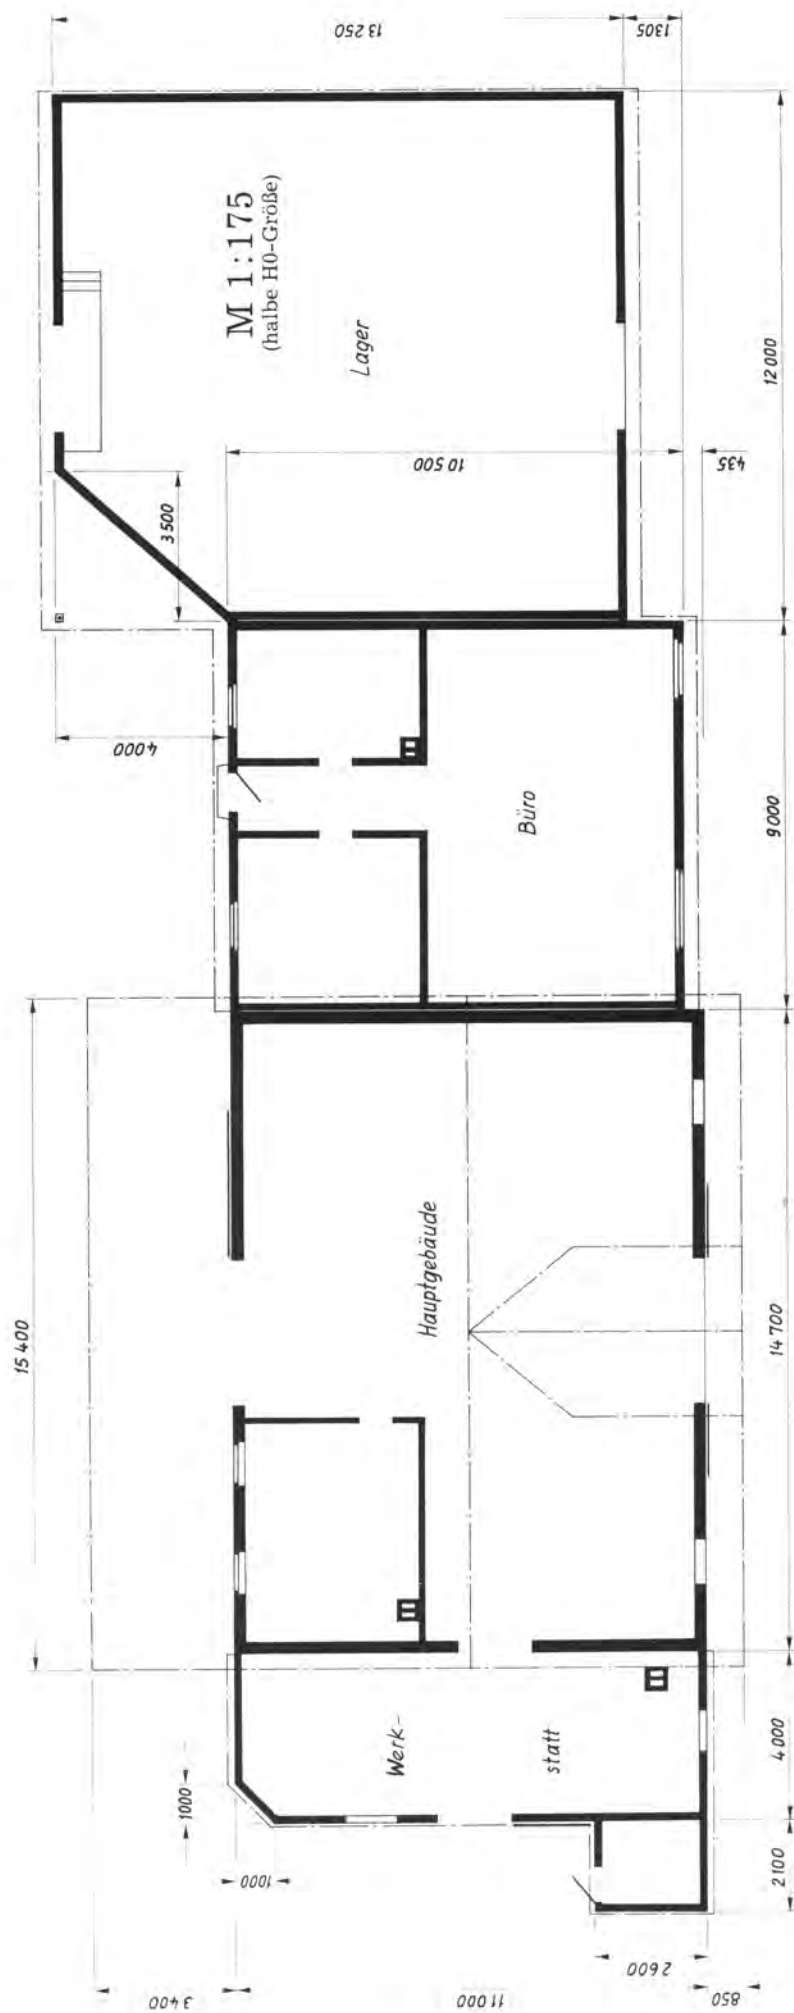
Der Grundriß aller beschriebenen Gebäude mit Originalmaßen (für den Modellbau bearbeitet).
